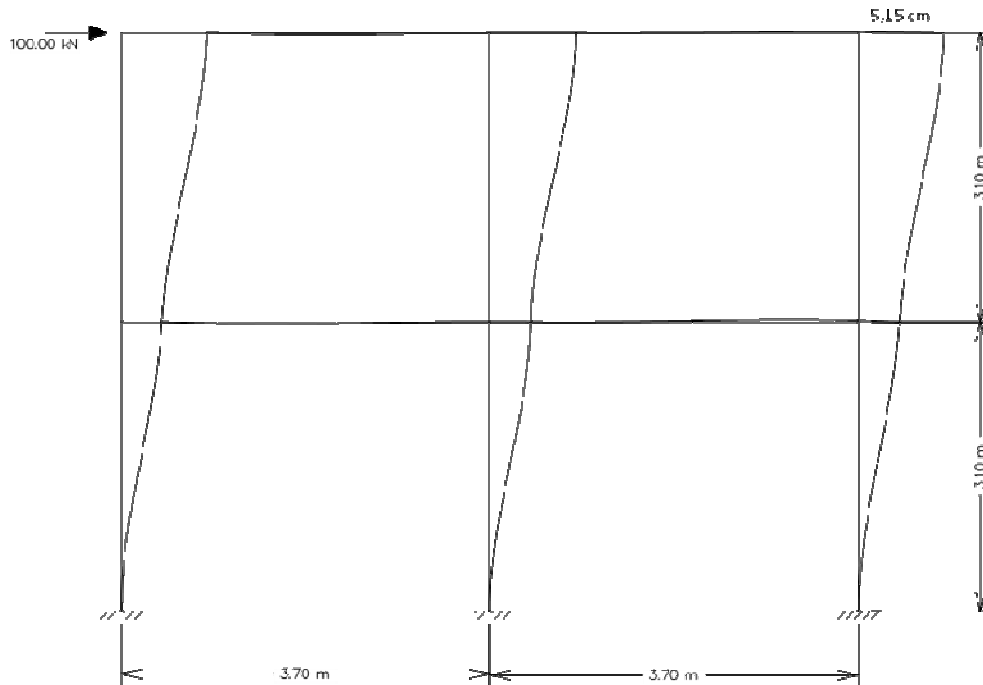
Modelo Estrutural com 02 Pavimentos
